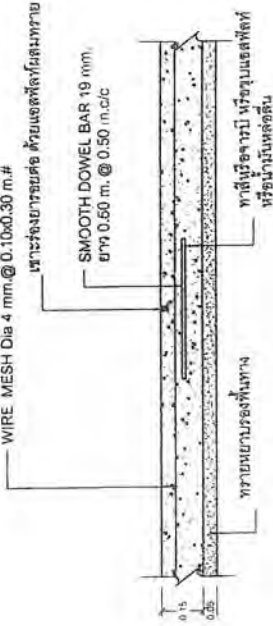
EXPANSION JOINT (รอยต่อเพื่อการขยายตัว)
